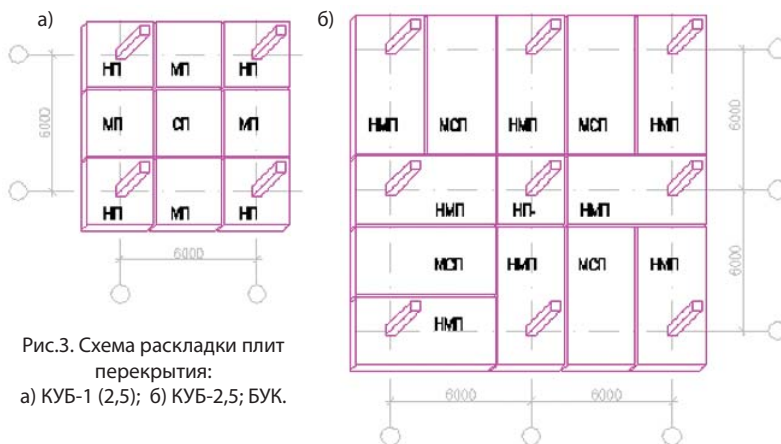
Схема раскладки плит перекрытия: а) КУБ-1 (2,5); б) КУБ-2,5; БУК.
